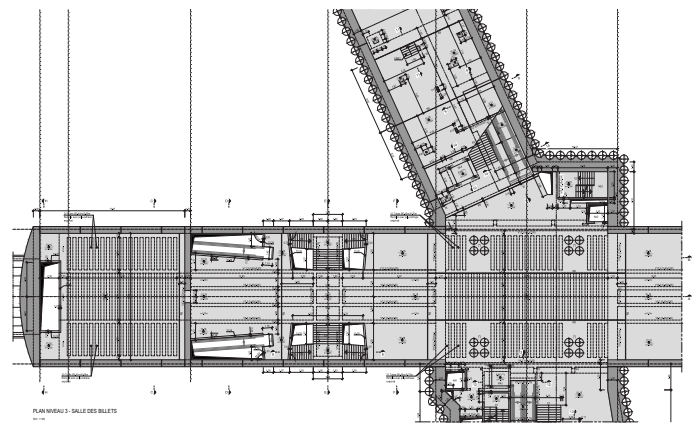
Estação de Beaulieu – Planta estrutural de acesso ao cais. Beaulieu Station – Structural plan of the access to the quay.
